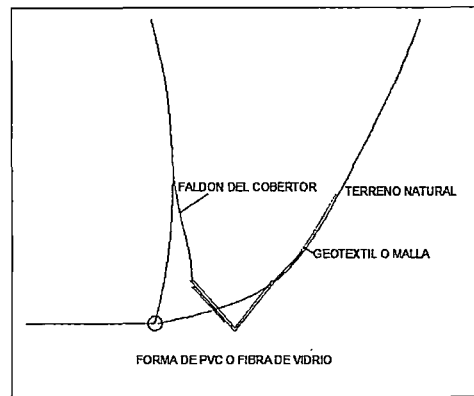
Propuesta 1 para el Drenaje Longitudinal
